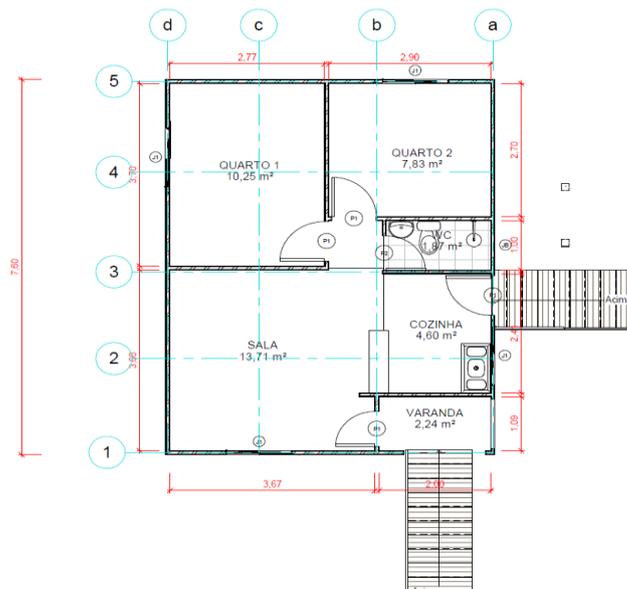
Planta baixa do projeto arquitetônico Unifamiliar
